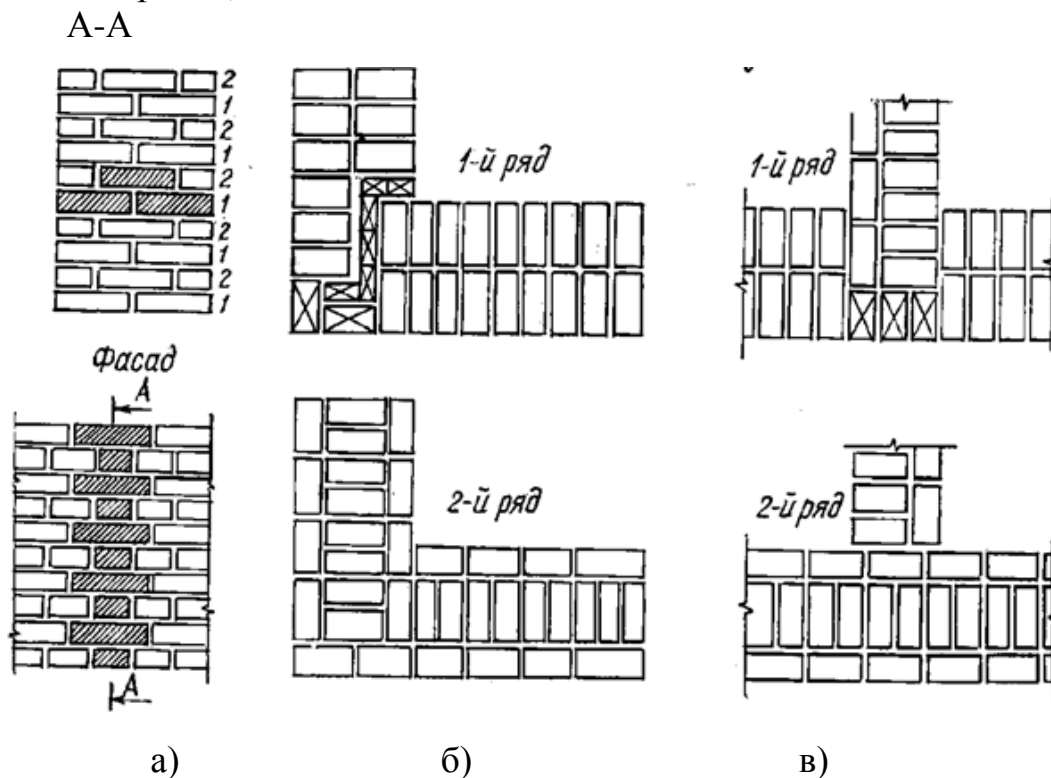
Однорядна система перев'язки швів: а — фасад; б — кладка прямих кутів і вертикальних обмежень; в — кладка примикань стін.
